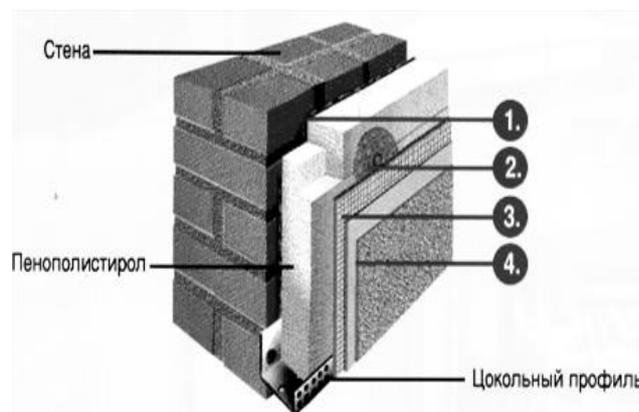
«мокрый» способ наружного утепления фасада по системе Atlas
